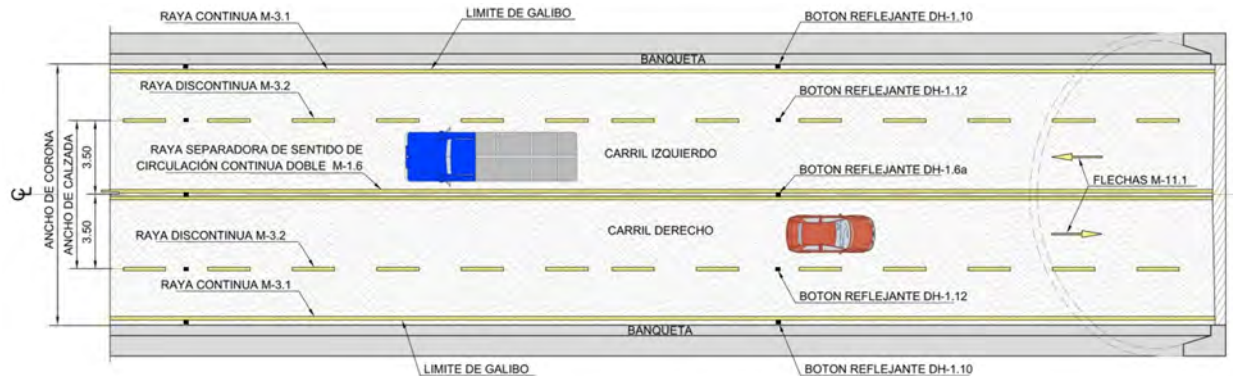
Señalamiento horizontal tipo, para túneles en carretera A2 (2 Carriles).
